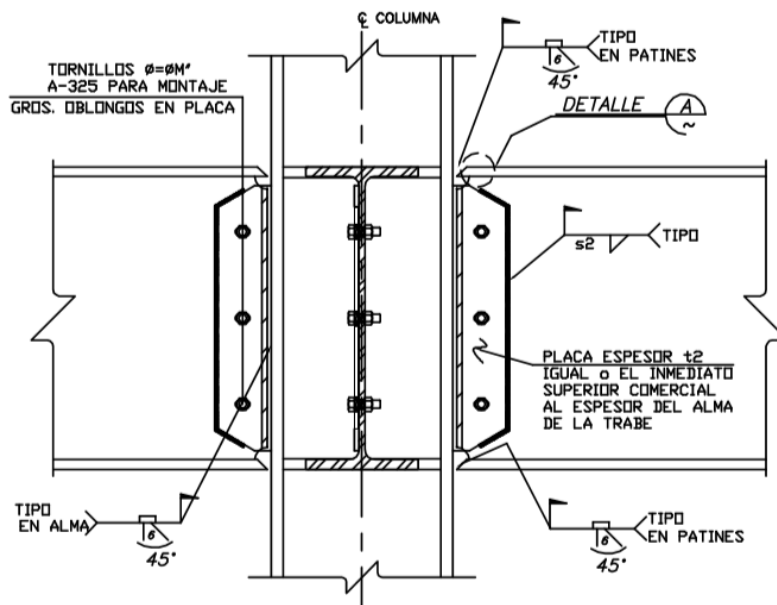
Elevación lateral de la conexión propuesta. (Manufacturas Metálicas AJAX, S.A. de C.V)
